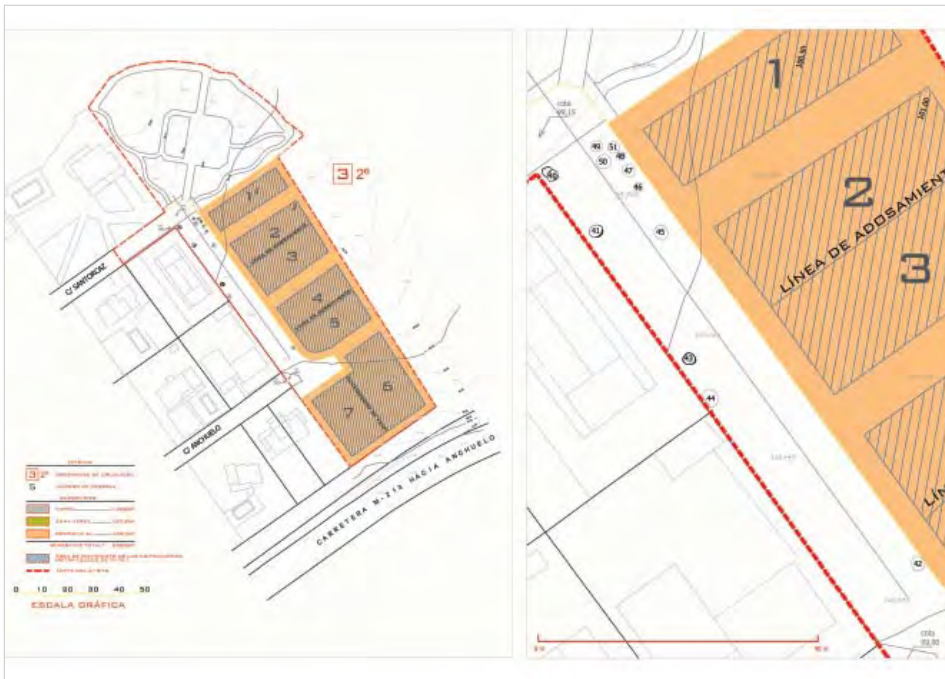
Planimetría de la parcela y planimetría en detalle del vial con los fondos documentados.
